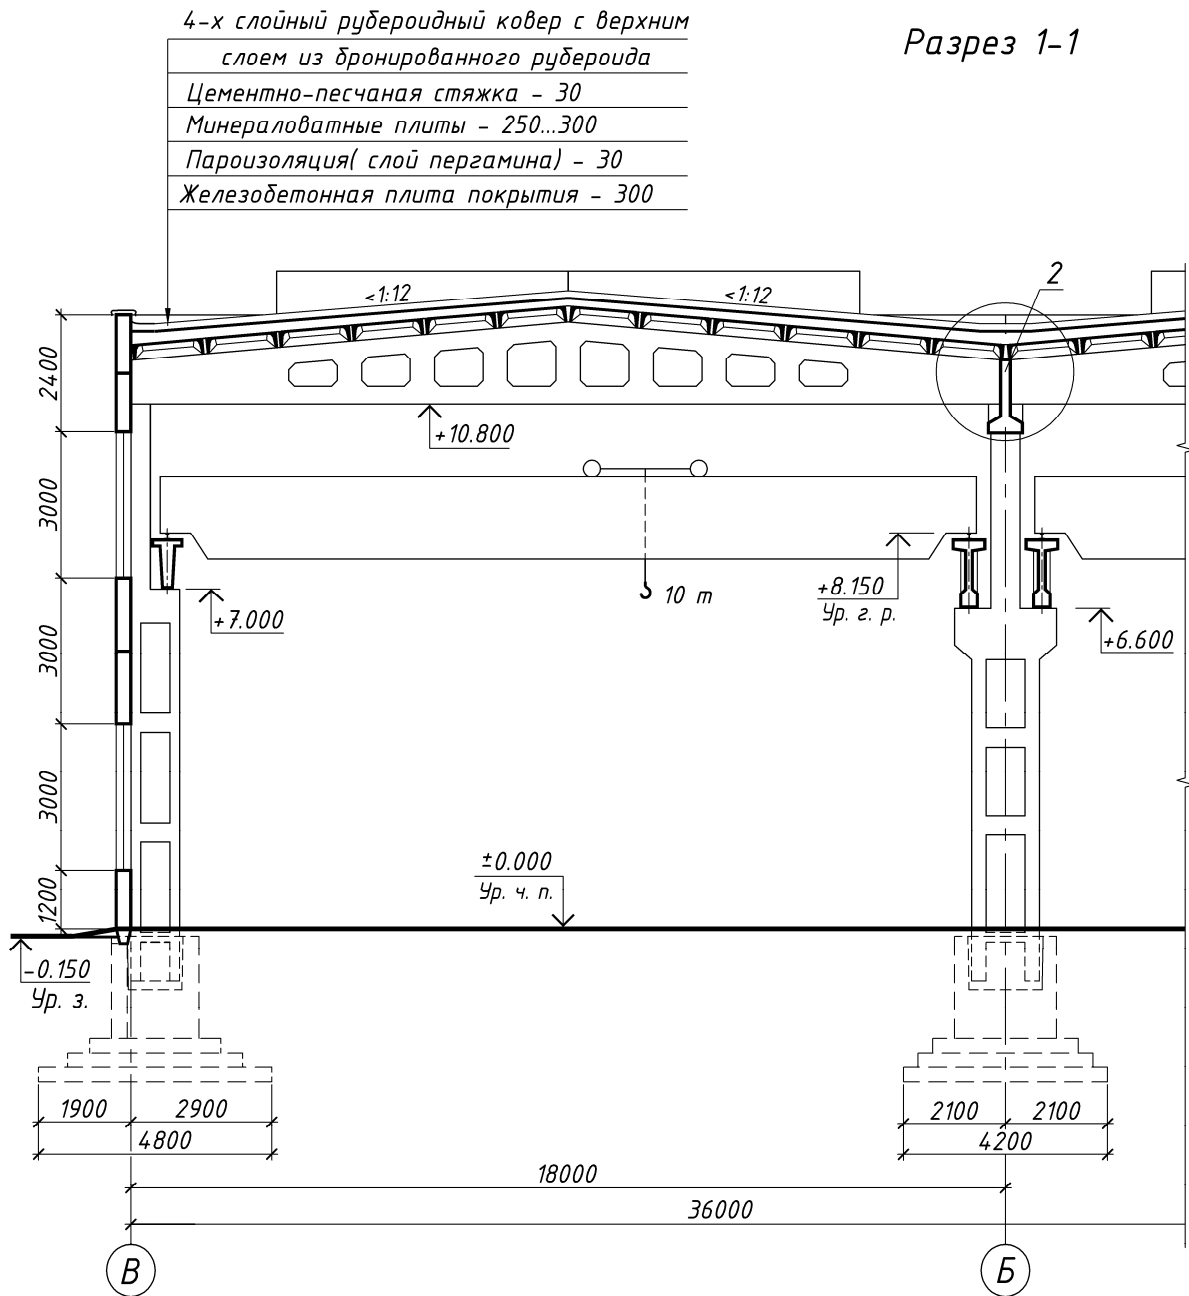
Фрагмент разреза (поперечный) промышленного здания каркасного типа
